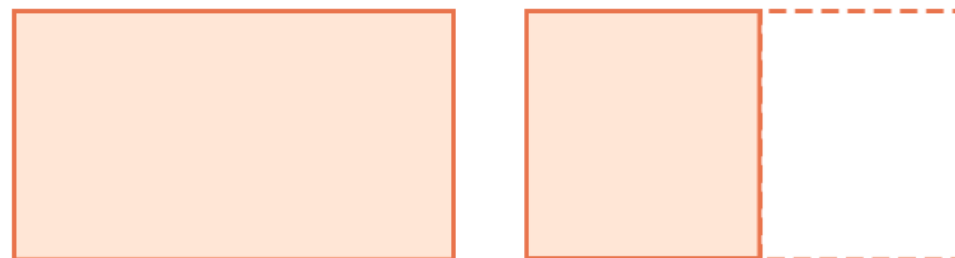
Planta inferior y superior de una vivienda 1 + ½ tipo. Fuente: Elaboración propia.
